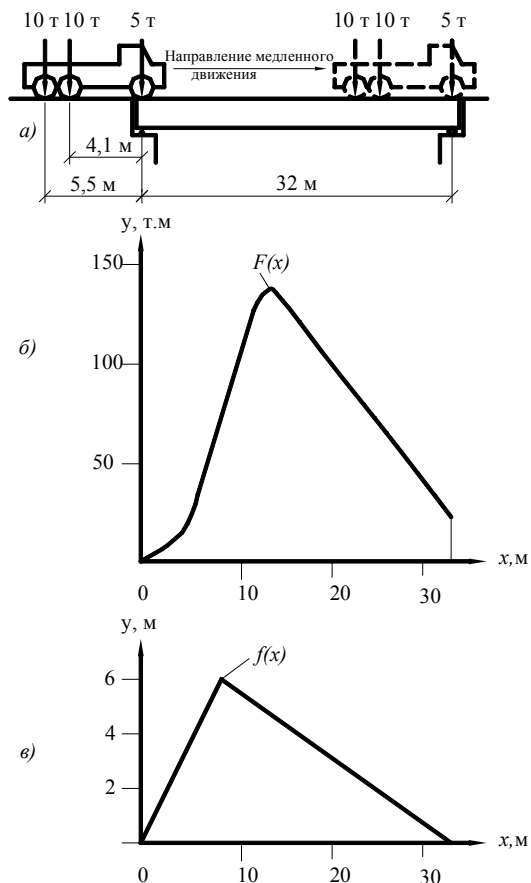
Схема загрузки балки колёсной испытательной нагрузкой:
